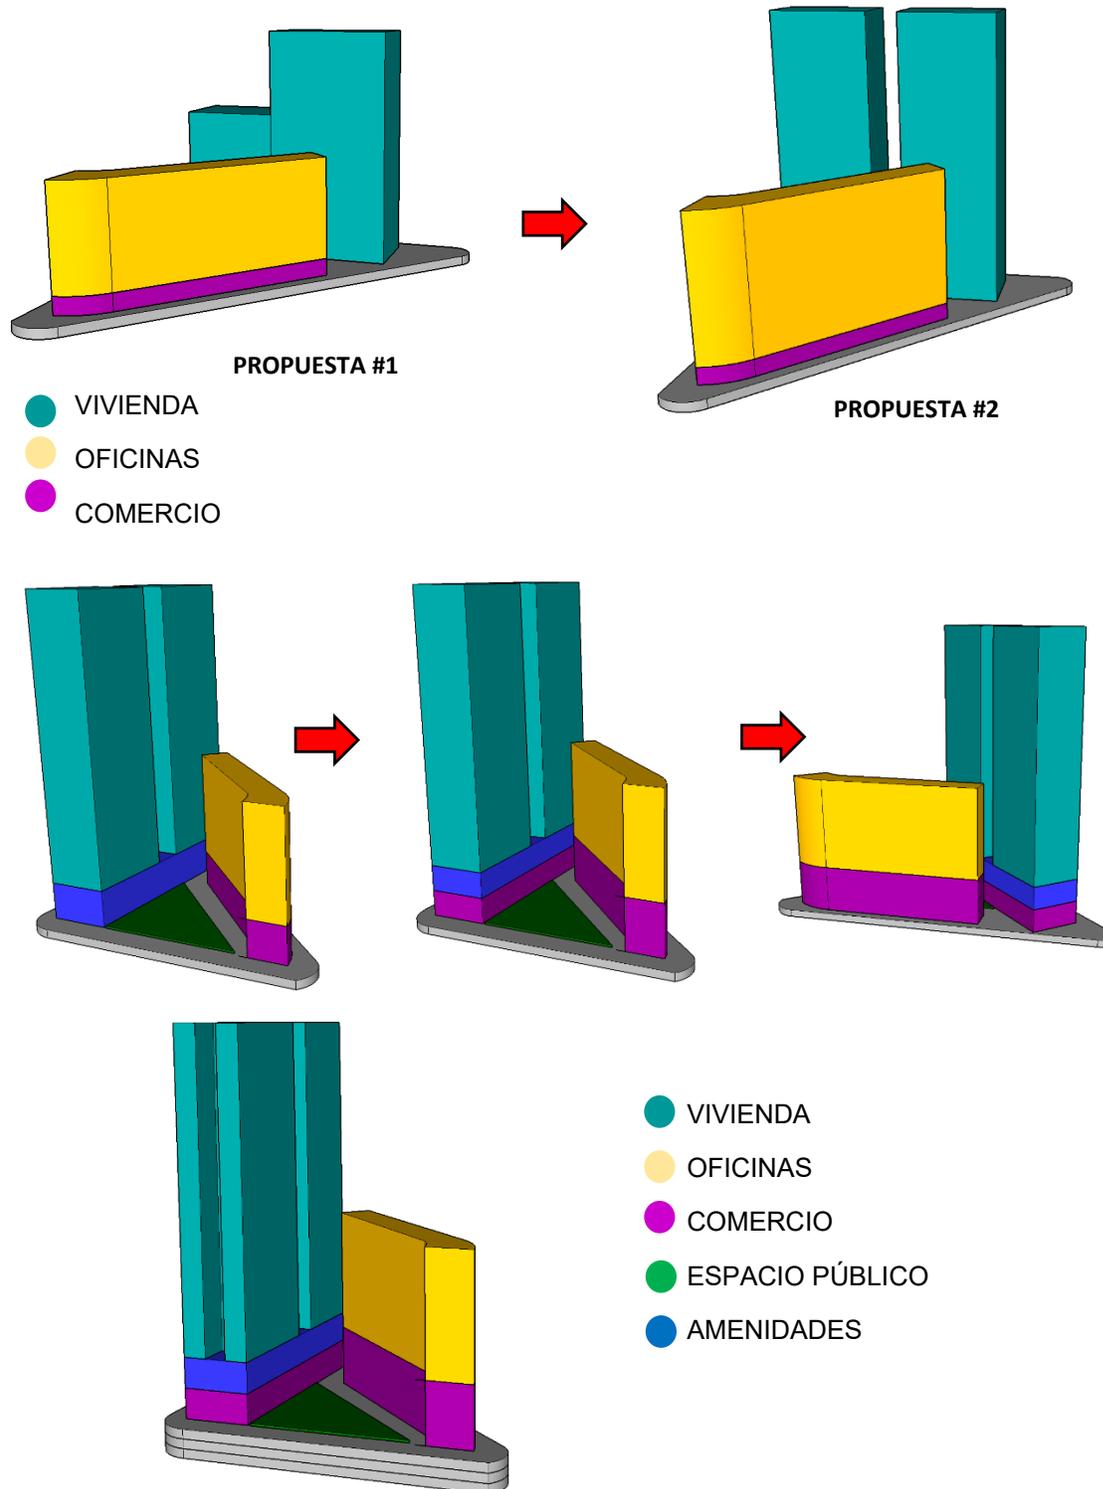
Proceso de propuesta 1 a propuesta 2 y final volumetría del proyecto
